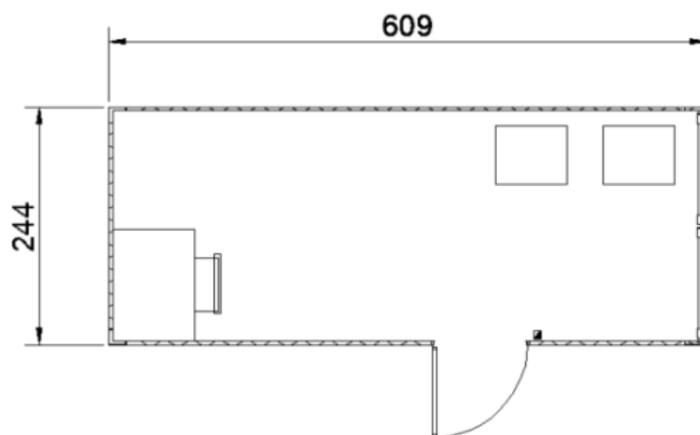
Planta de edificio de control con dimensiones (cm)
